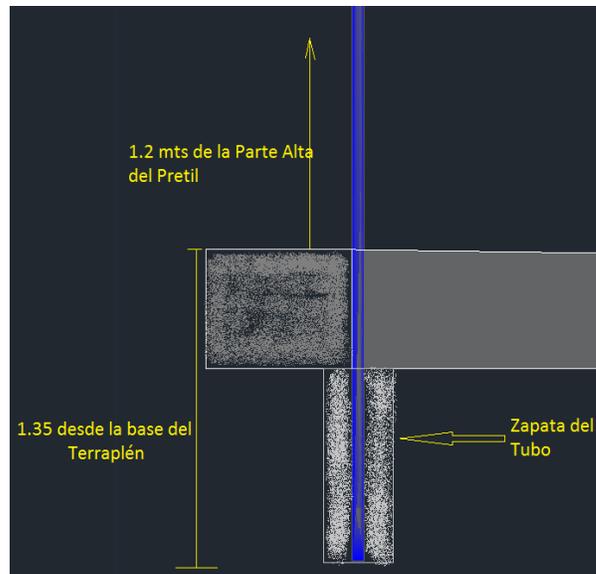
Corte del poste y la zapata para fijarlo.
